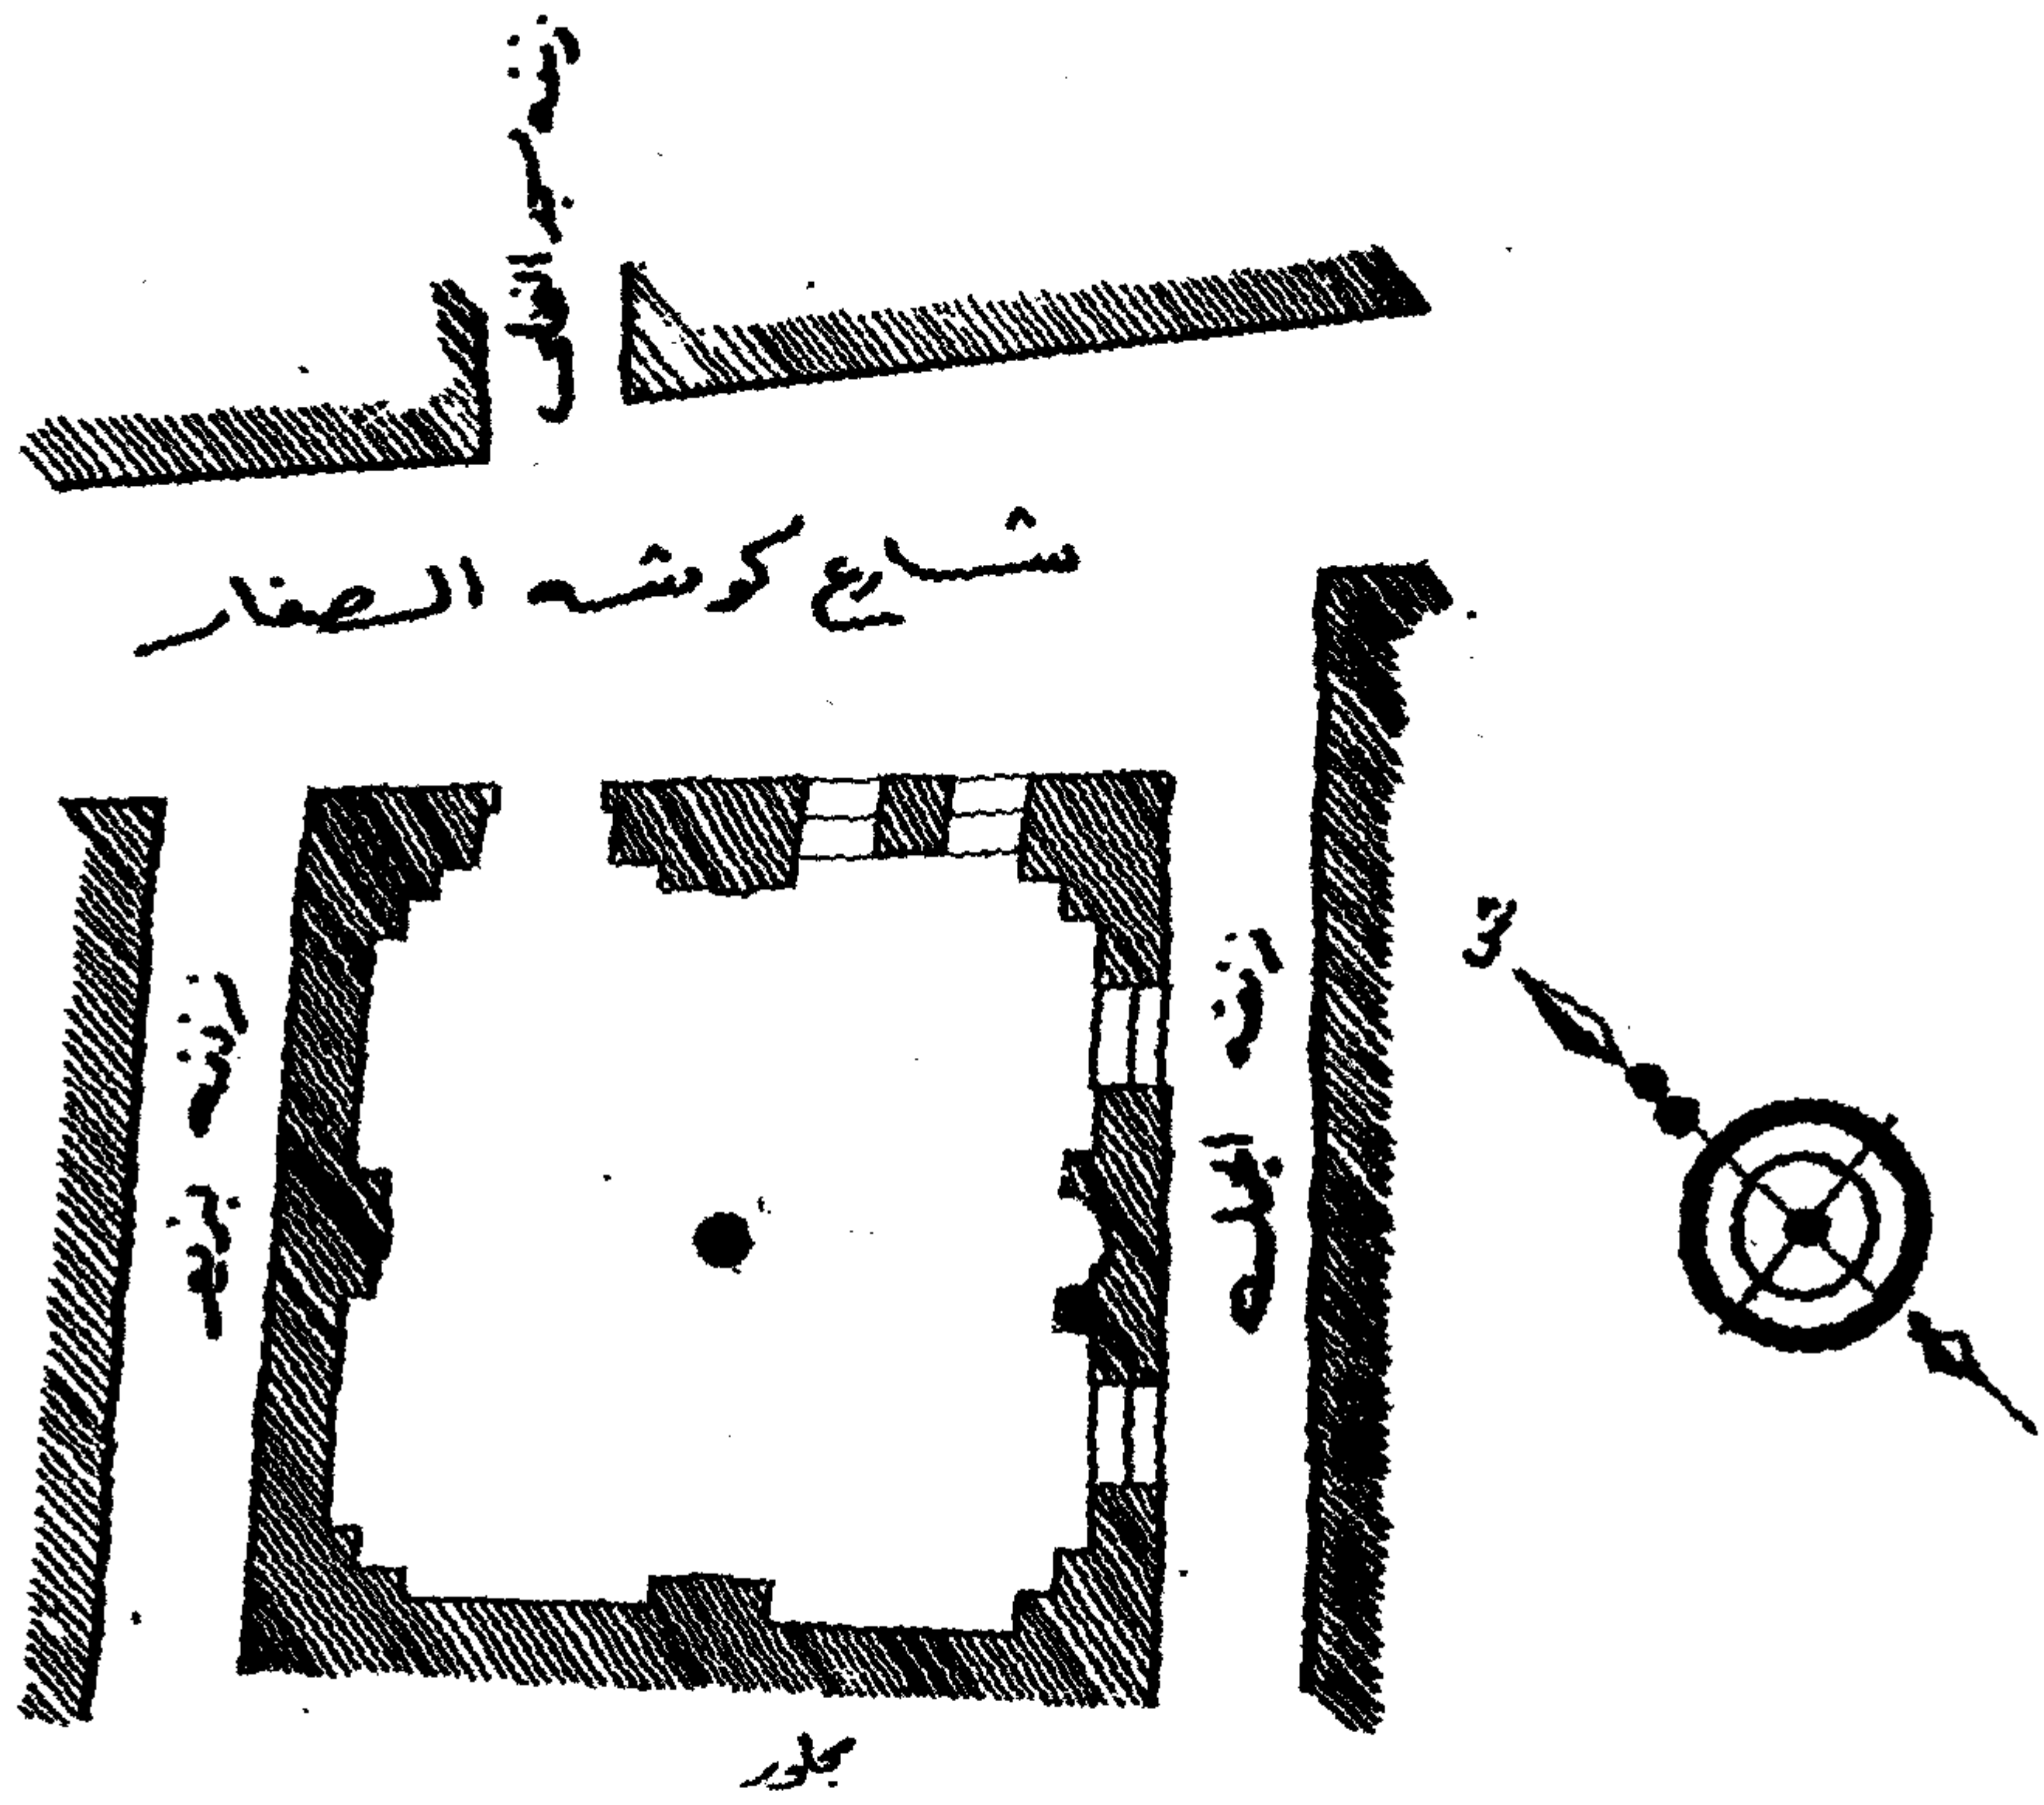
مسقط أفقي لمسجد أحمد بن محمد عن موسوعة الآثار الإسلامية.
